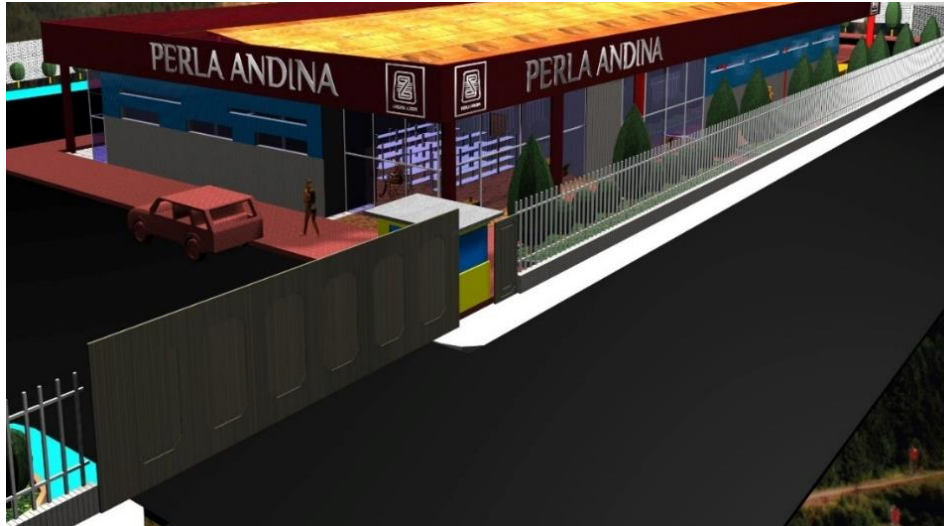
Modelado 3D de la planta - Acceso vehicular y peatonal.
